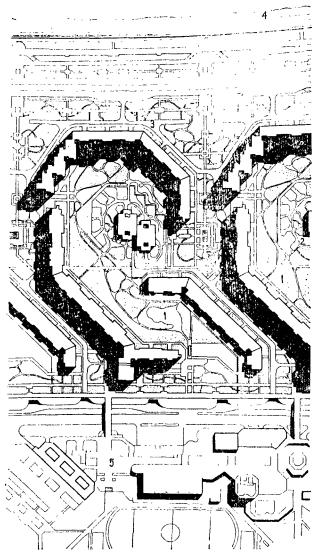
Экспериментальный жилой комплекс. Фрагмент генплана
